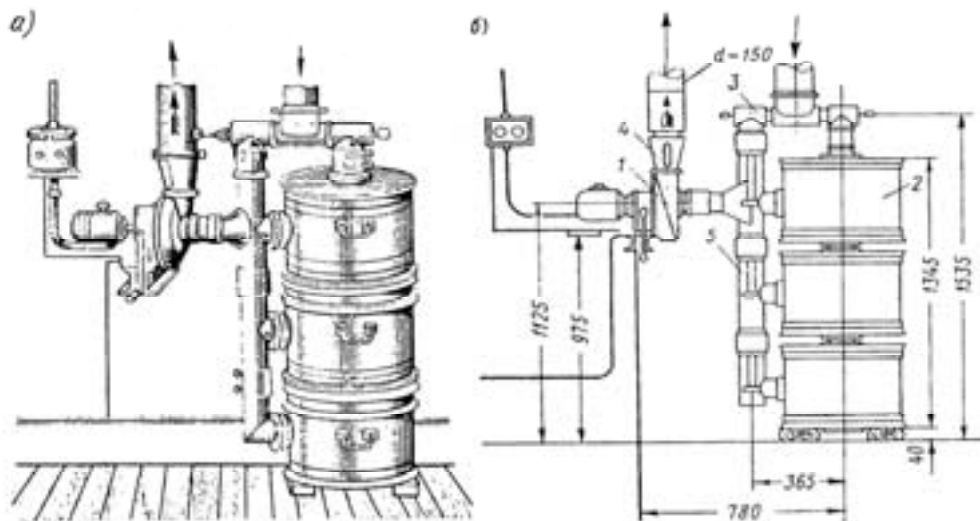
Фільтровентиляційний агрегат ФВА-49: а) загальний вигляд; б) основні габаритні розміри; 1 – електроручний вентилятор ЕРВ-49; 2 – фільтри-поглиначі; 3 – здвоєний герметичний клапан; 4 – витратомір; 5 – з'єднувальні частини.
